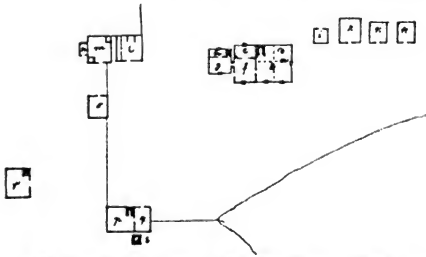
Grundriss desselben Bauerhofes.
